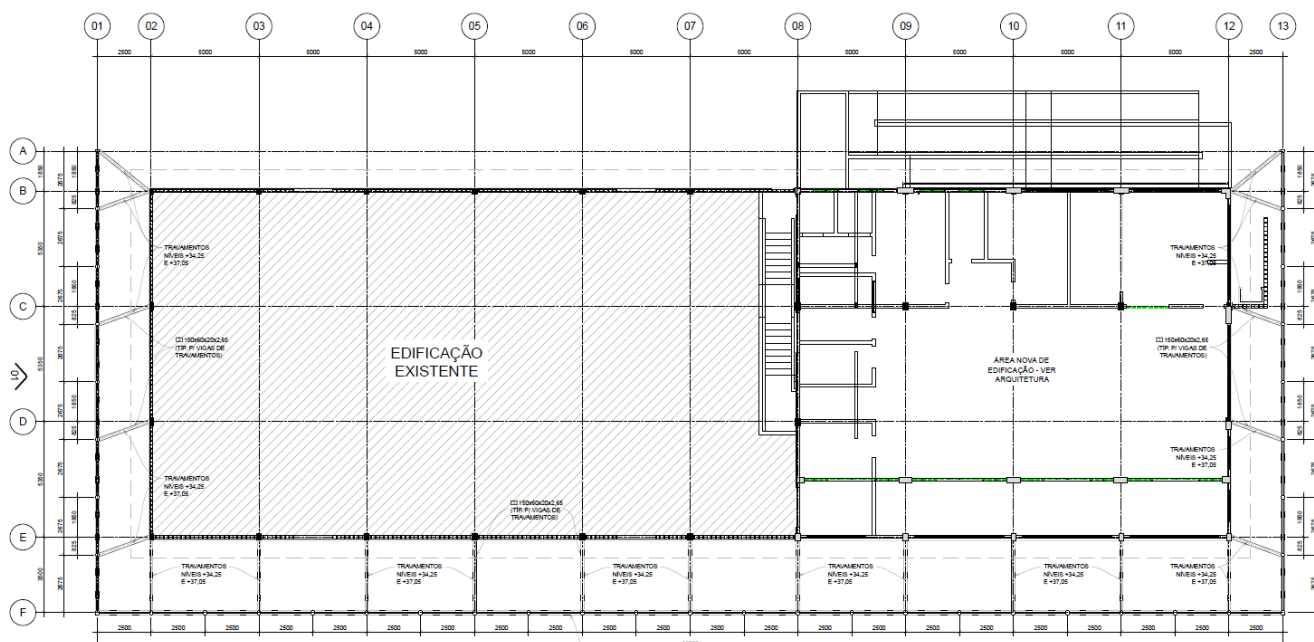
Planta de locação das fachadas metálicas do Galpão da UDR
